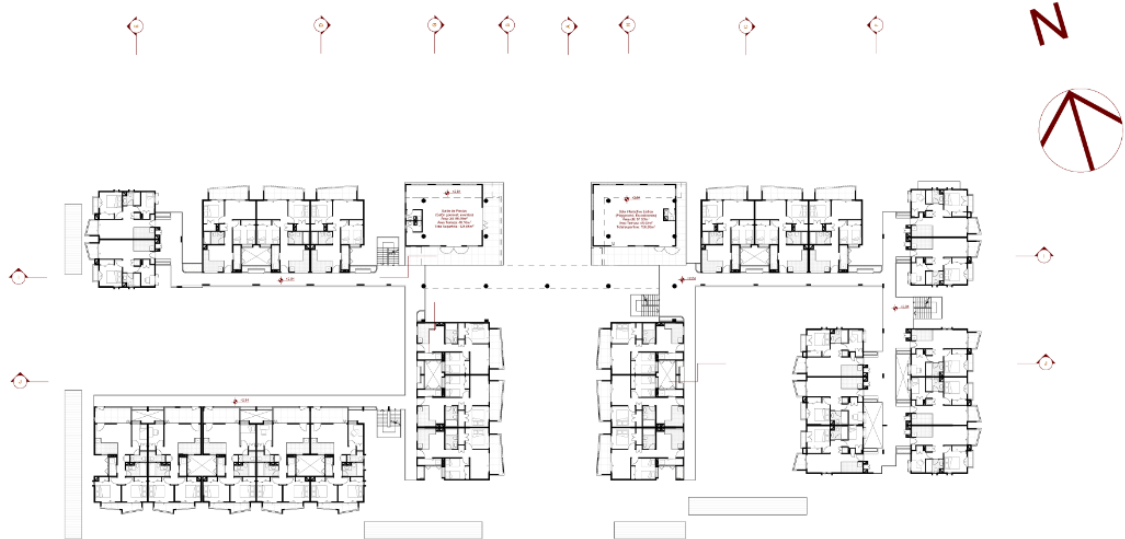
Plano esquemático del Nivel 1 con zonificación según tipos áreas del proyecto - Bueno,E. 2021
